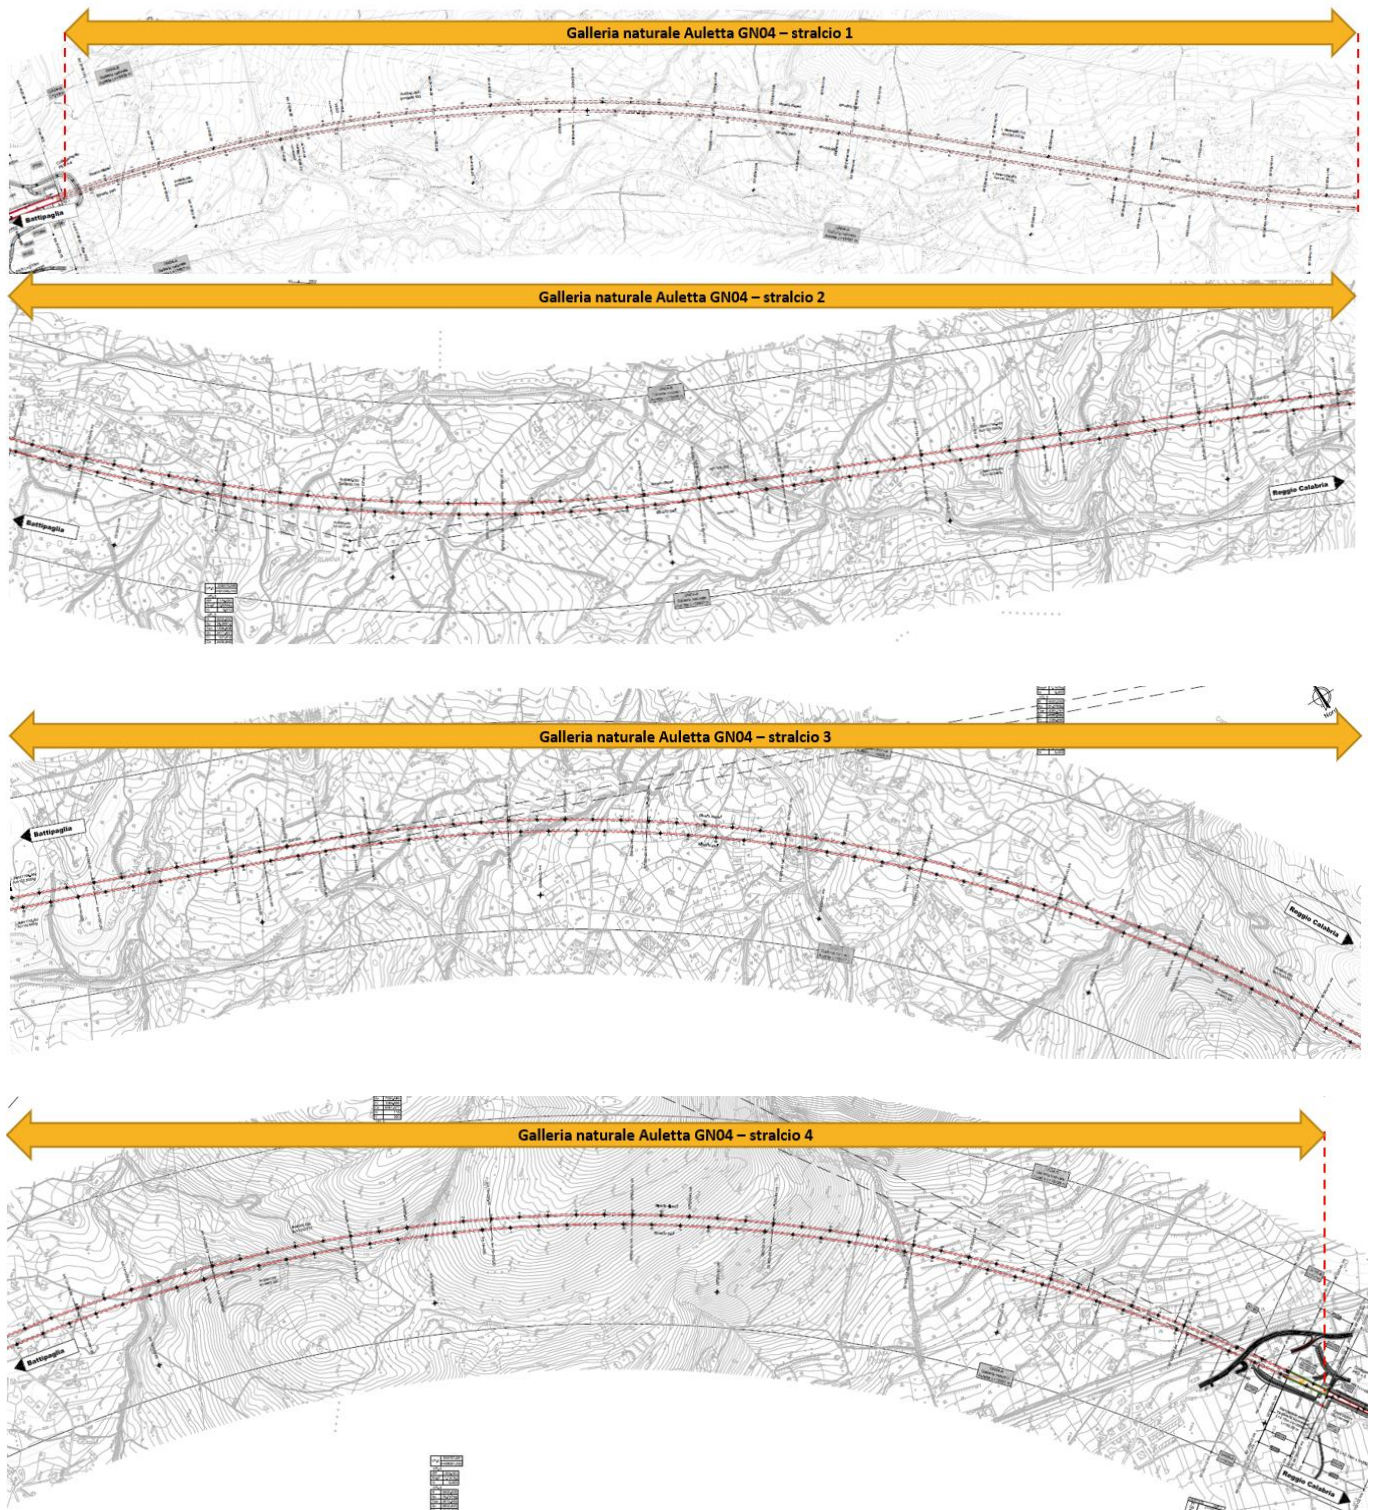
Planimetria galleria naturale GN04 da km 6+188 a km 21+927 BP
